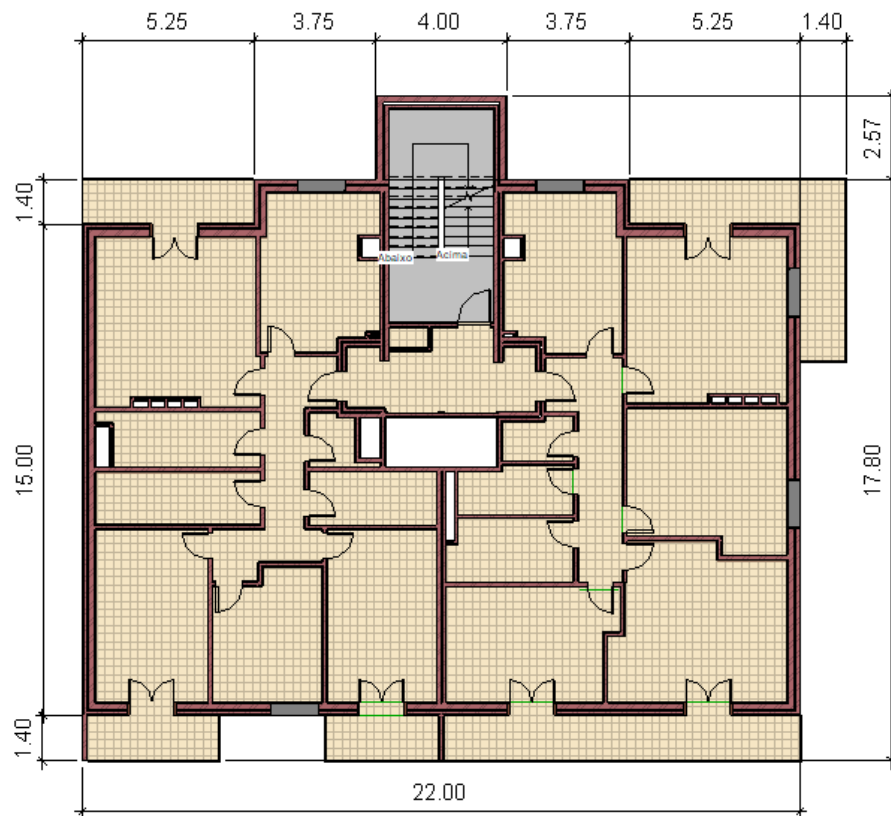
Planta arquitetônica do piso tipo (Revit).
